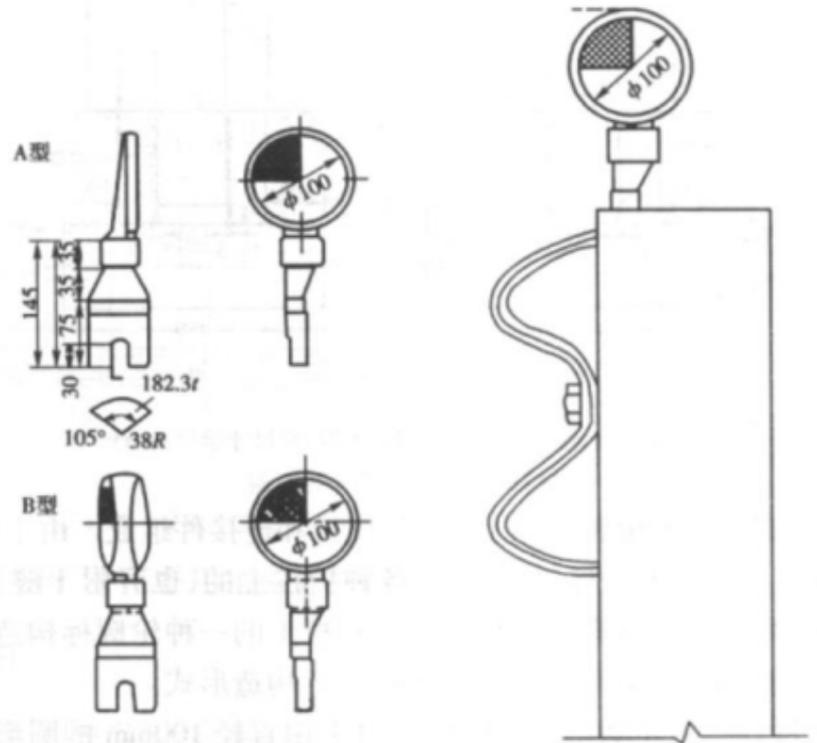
轮廓标安装于波形钢板护栏立柱上(尺寸单位:mm)
